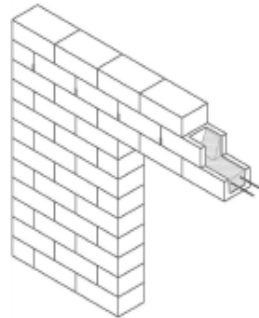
Formazione dell'architrave di porta con blocco a canaletta riempito in calcestruzzo armato
